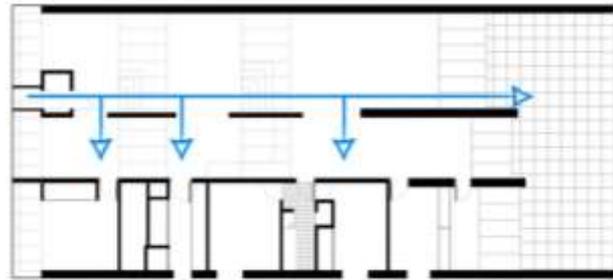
Planta de Jaffe House mostrando el recorrido.
